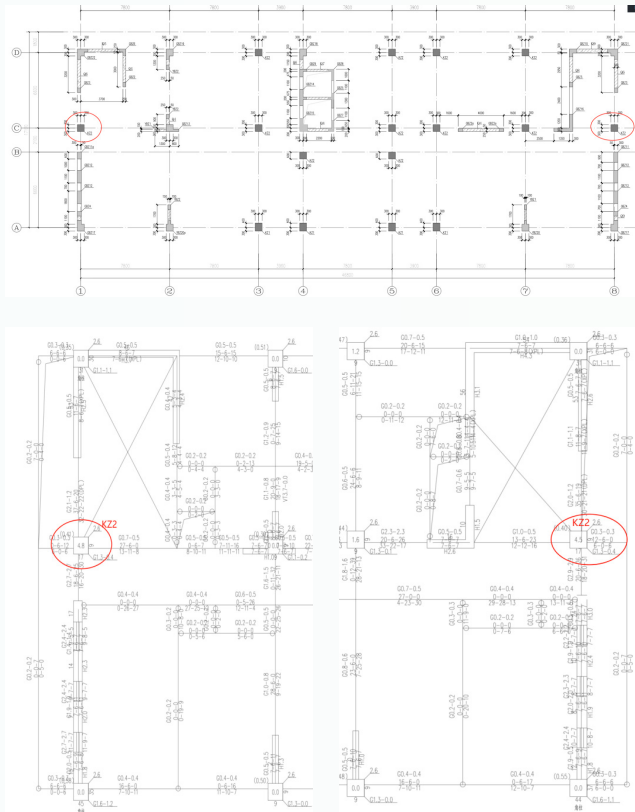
综合办公楼首层柱配筋平面图及配筋简图(局部)
